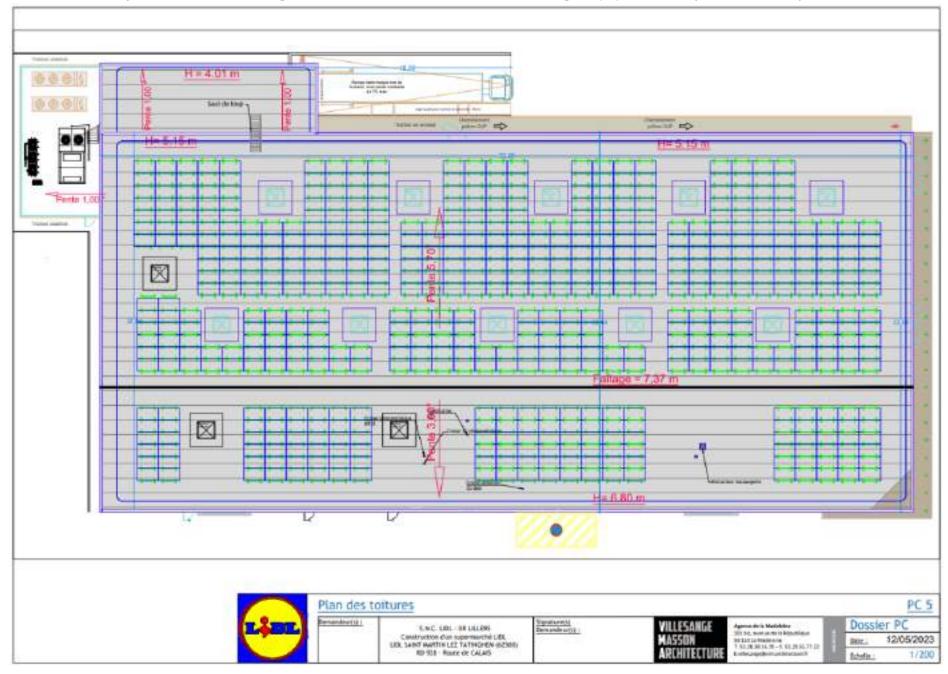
Plan des toitures; Source: Villesange Masson Architecture
